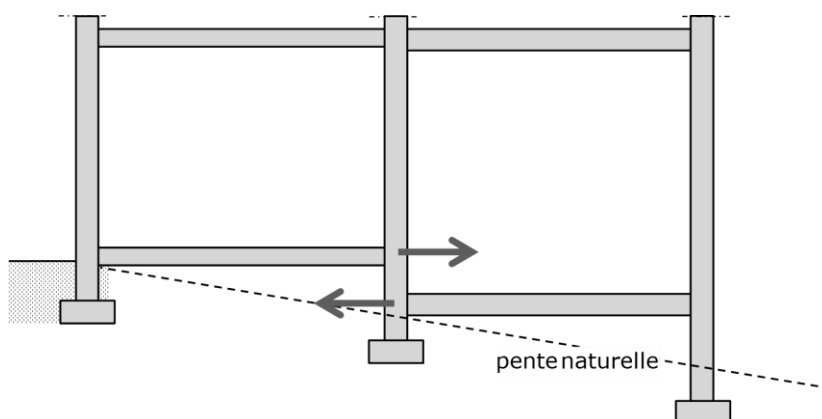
sollicitations supplémentaires sur les bâtis mitoyens dont les planchers sont décalés
